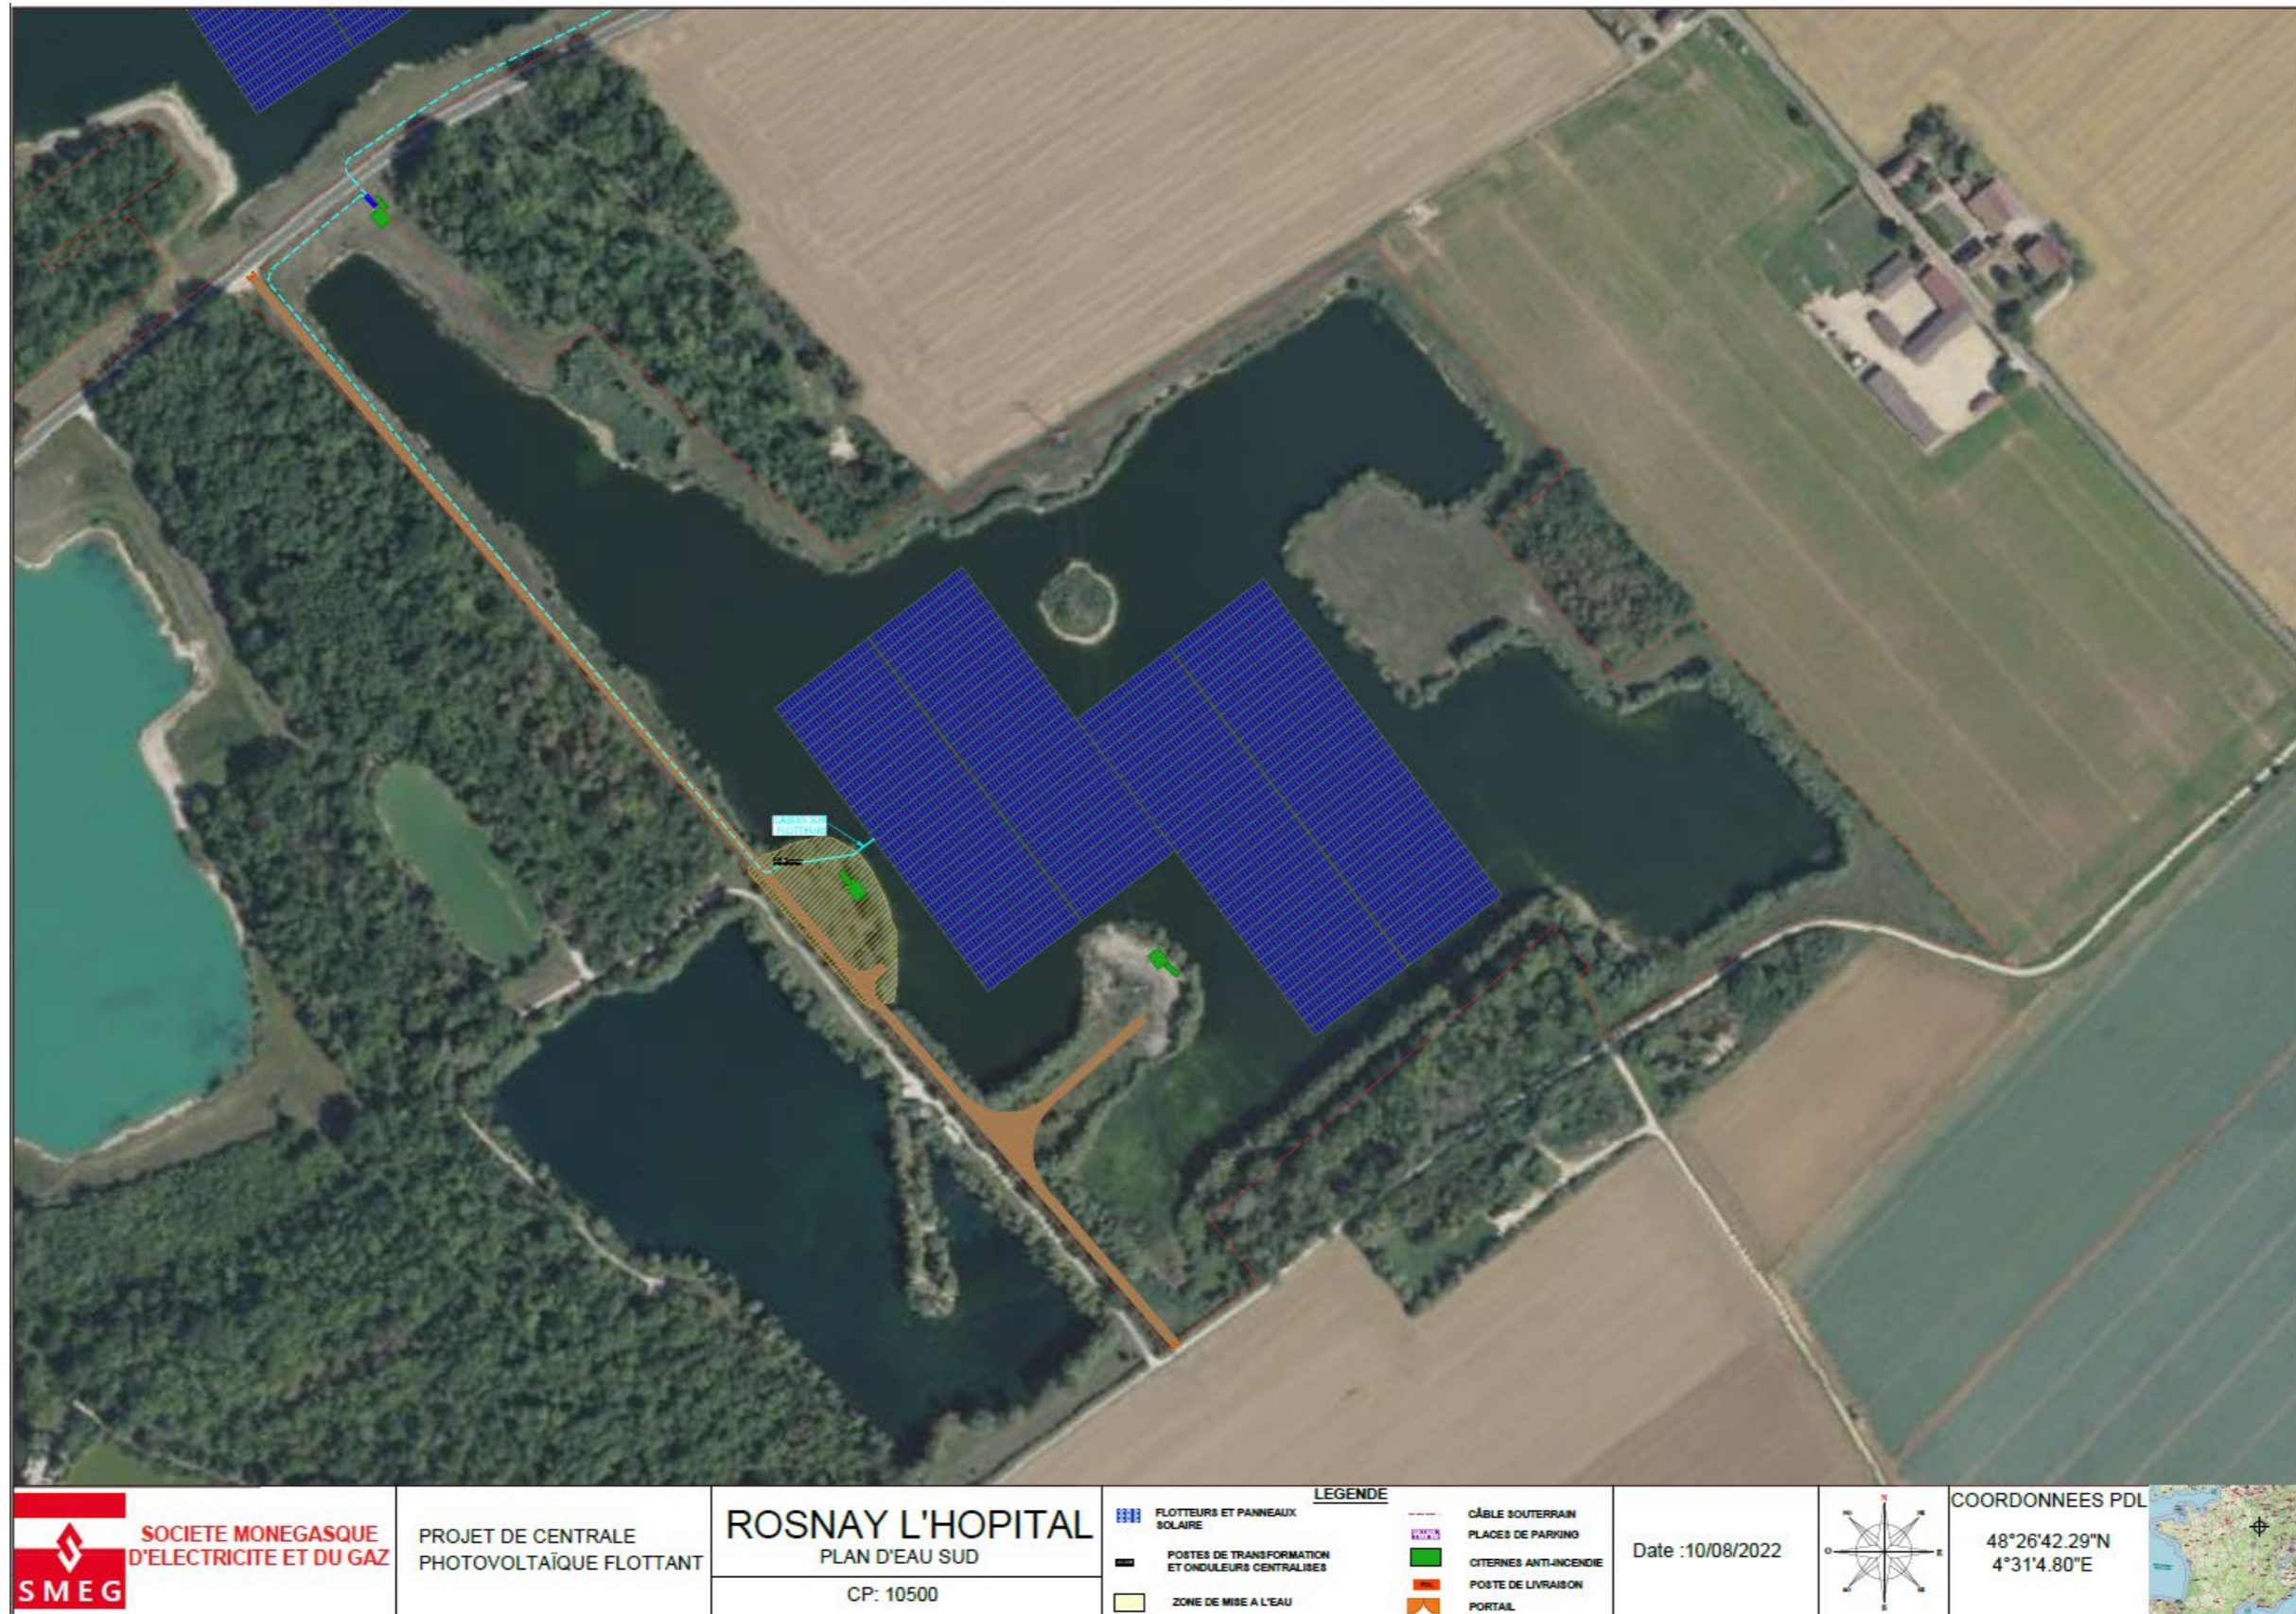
Plan de masse de la centrale Sud (plan d'eau Sud) (Source : SMEG)
